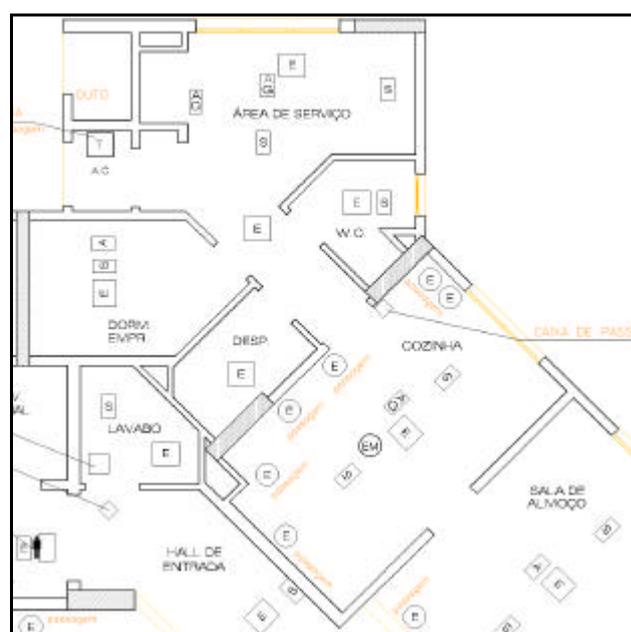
Detalhe de planta de teto do projeto de elétrica.
